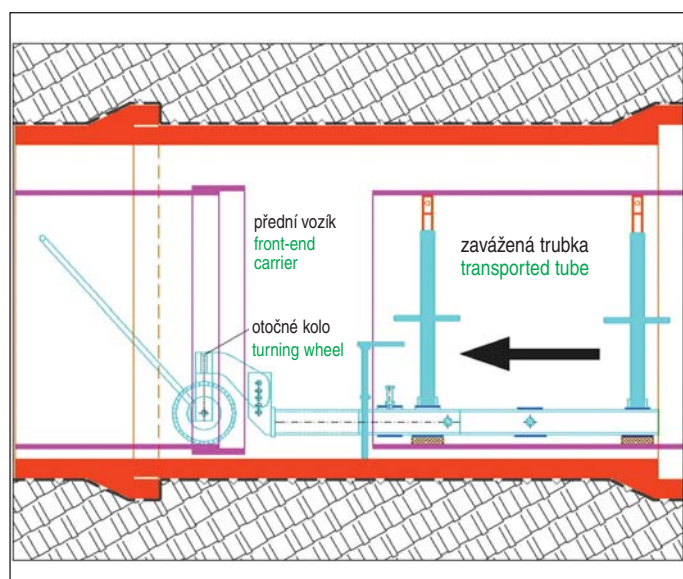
Zavážení trubek GRP – proplachovací kanál
